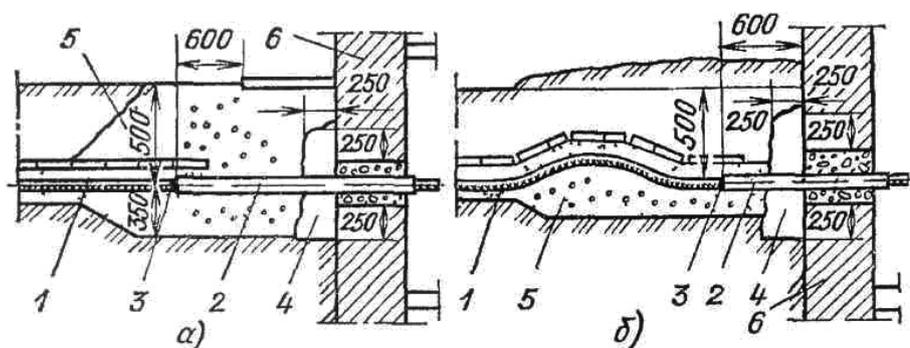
23. Ввод кабеля через трубу в здания или кабельные сооружения: а – при отсутствии просадок грунта, б – при ожидании просадки грунта: 1 – кабель; 2 – труба; 3 – уплотнение; 4 – гидроизоляция; 5 – песок без примесей глины и камней; 6 – стена здания
